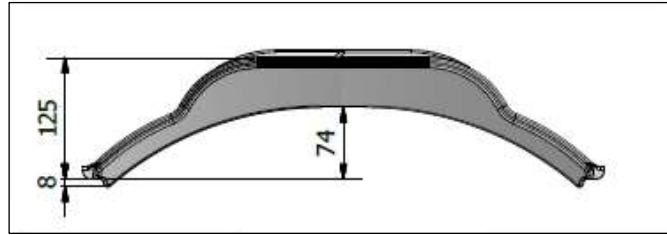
Prescription de forme pour les entrevous Neobois hauteur coffrante 160 mm et poutrelles DF
